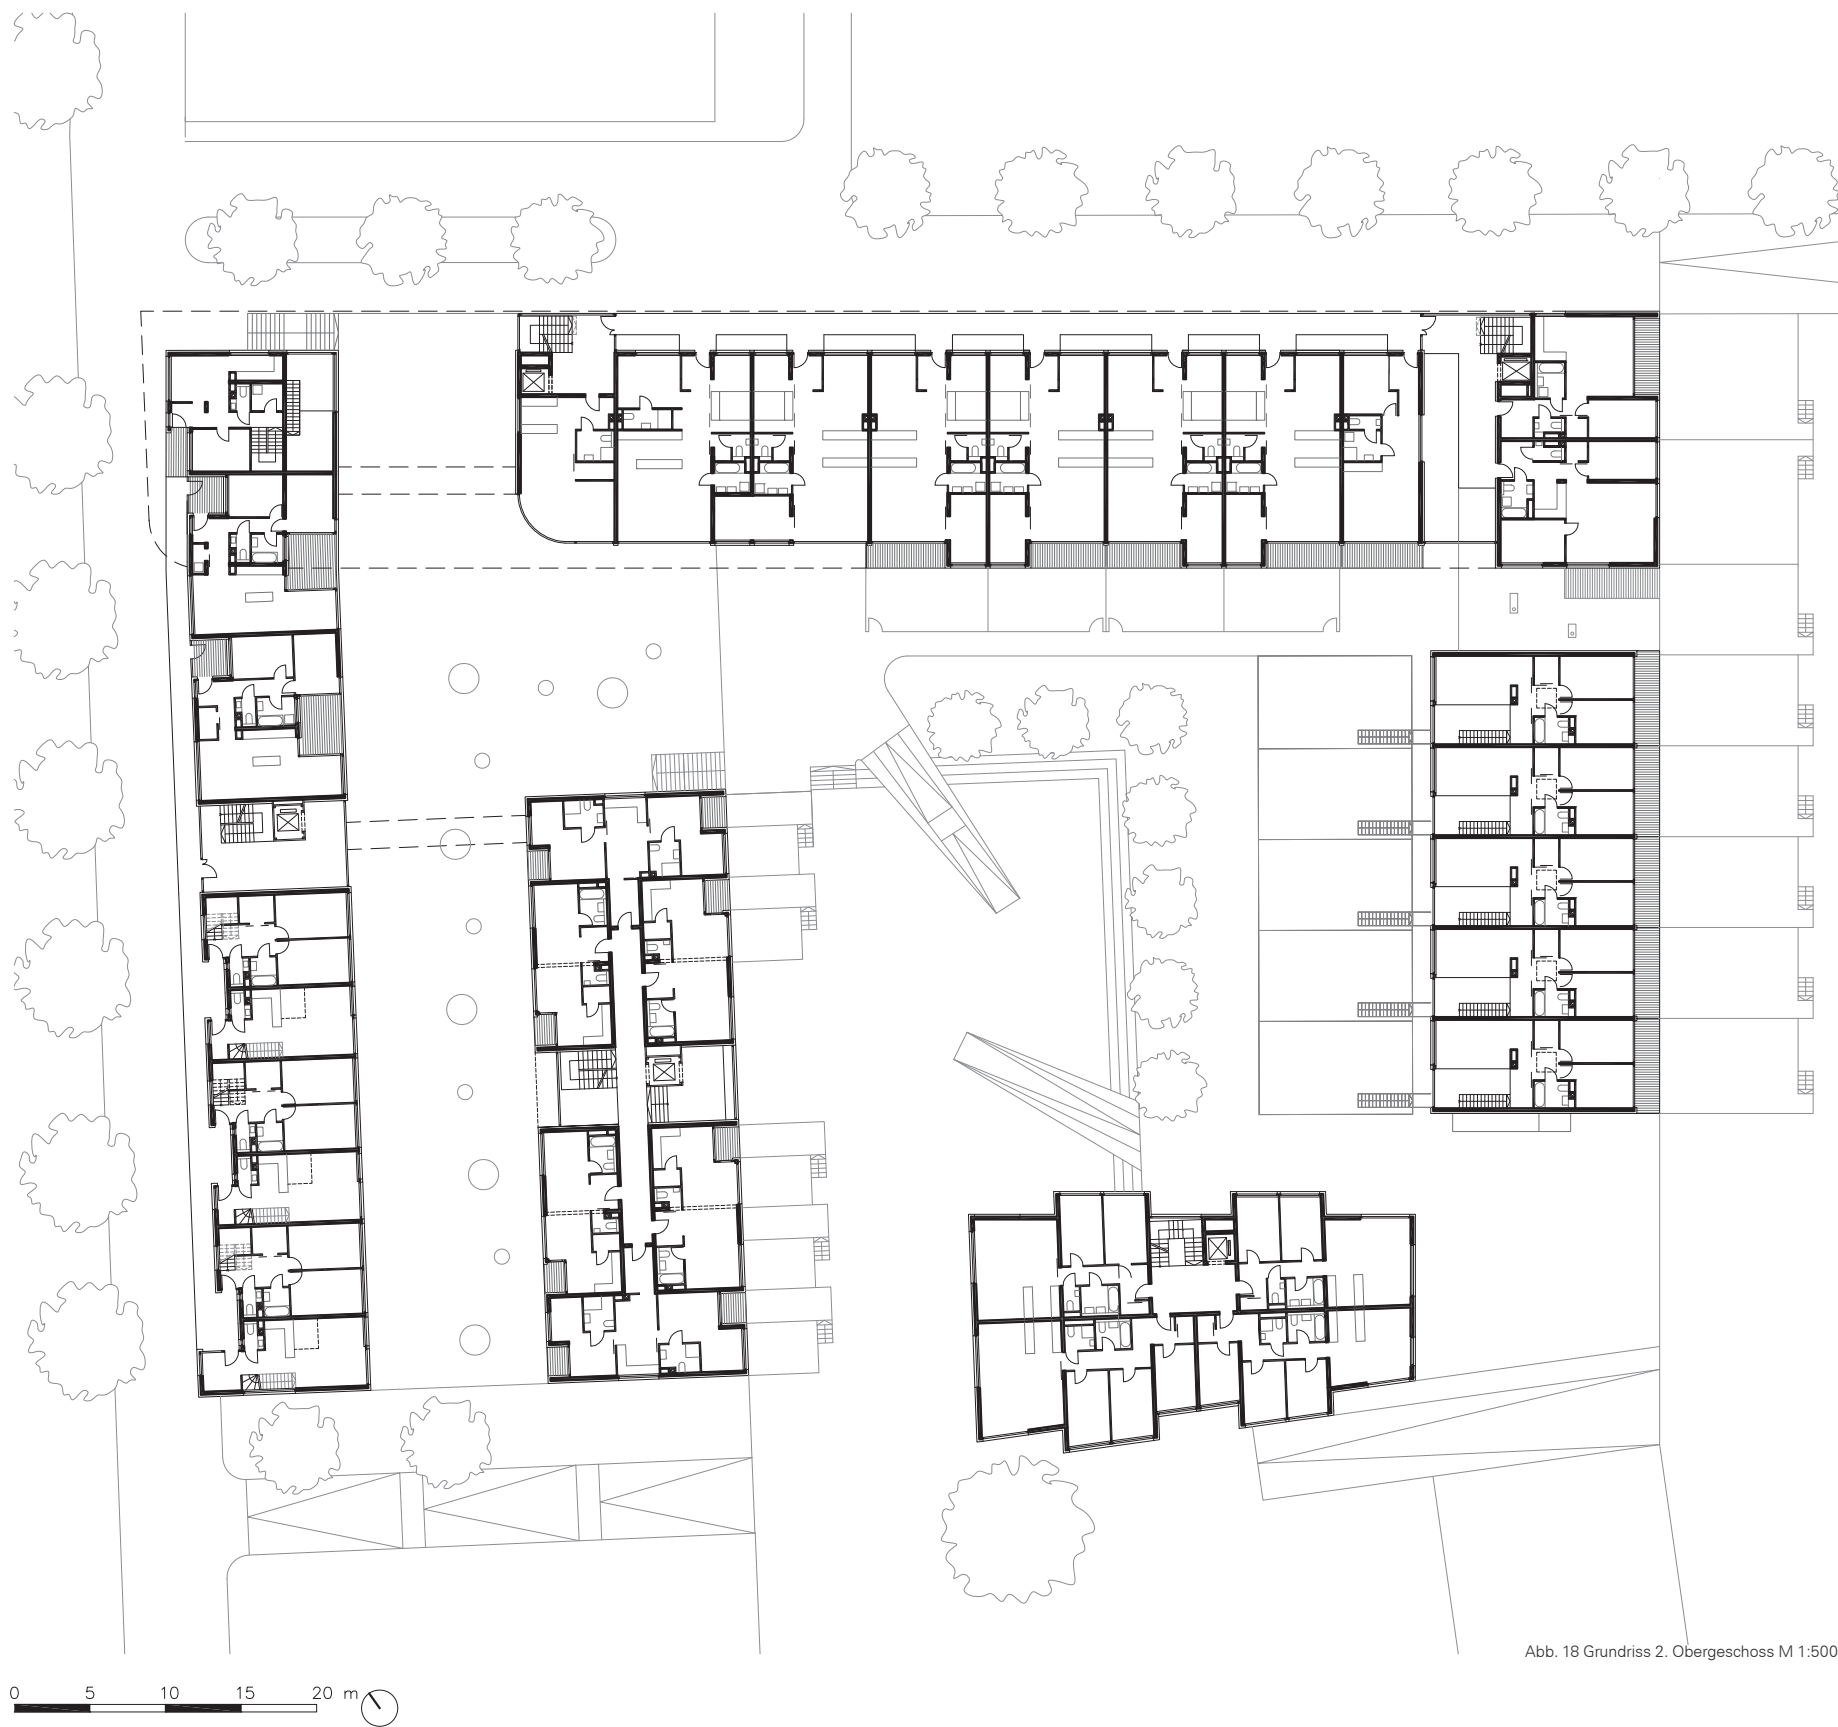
Grundriss 2. Obergeschoss M 1:500
